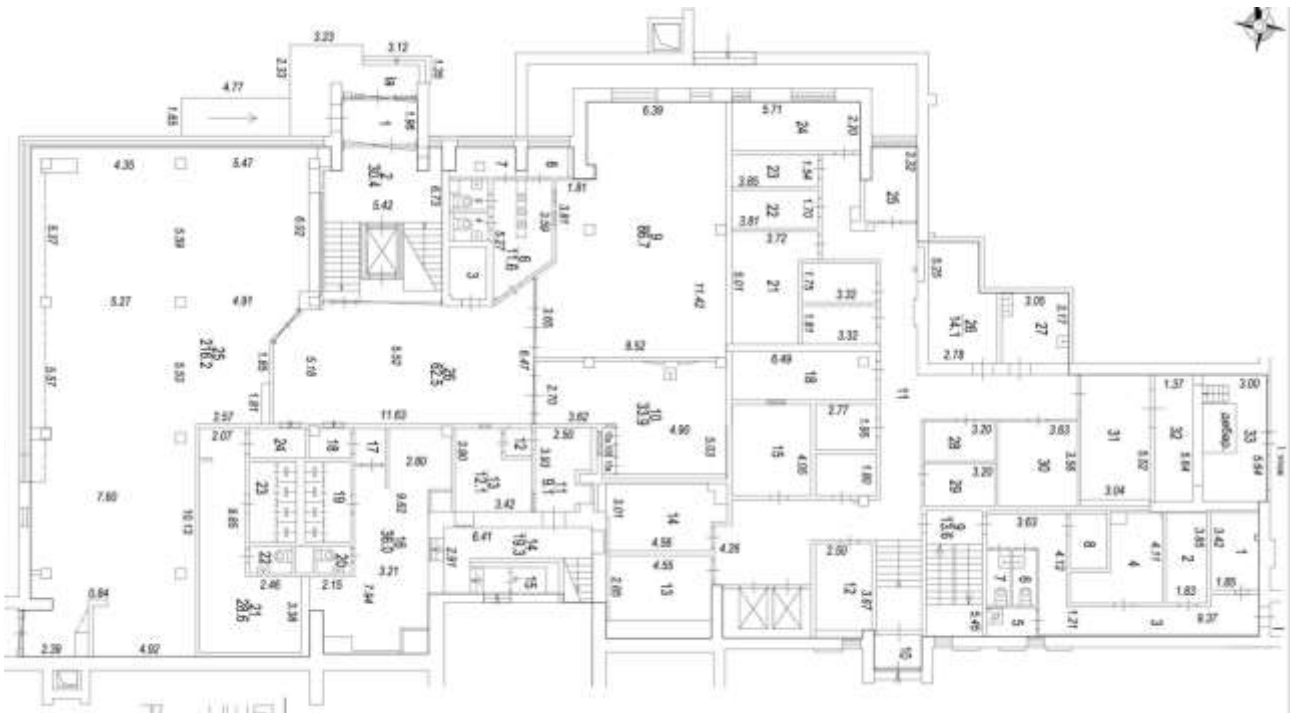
Схема оцениваемых помещений на поэтажных планах (1 этаж)
